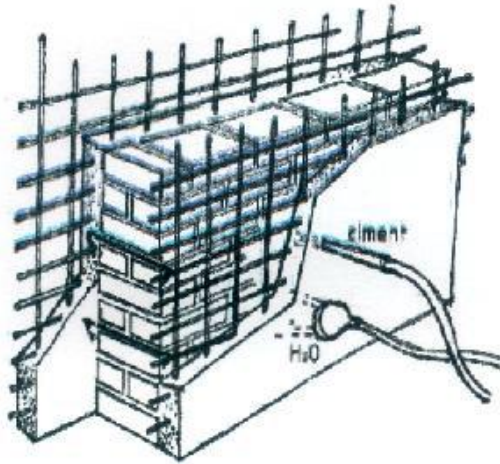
Consolidation d'un mur en pierre par parois armées. [32]
